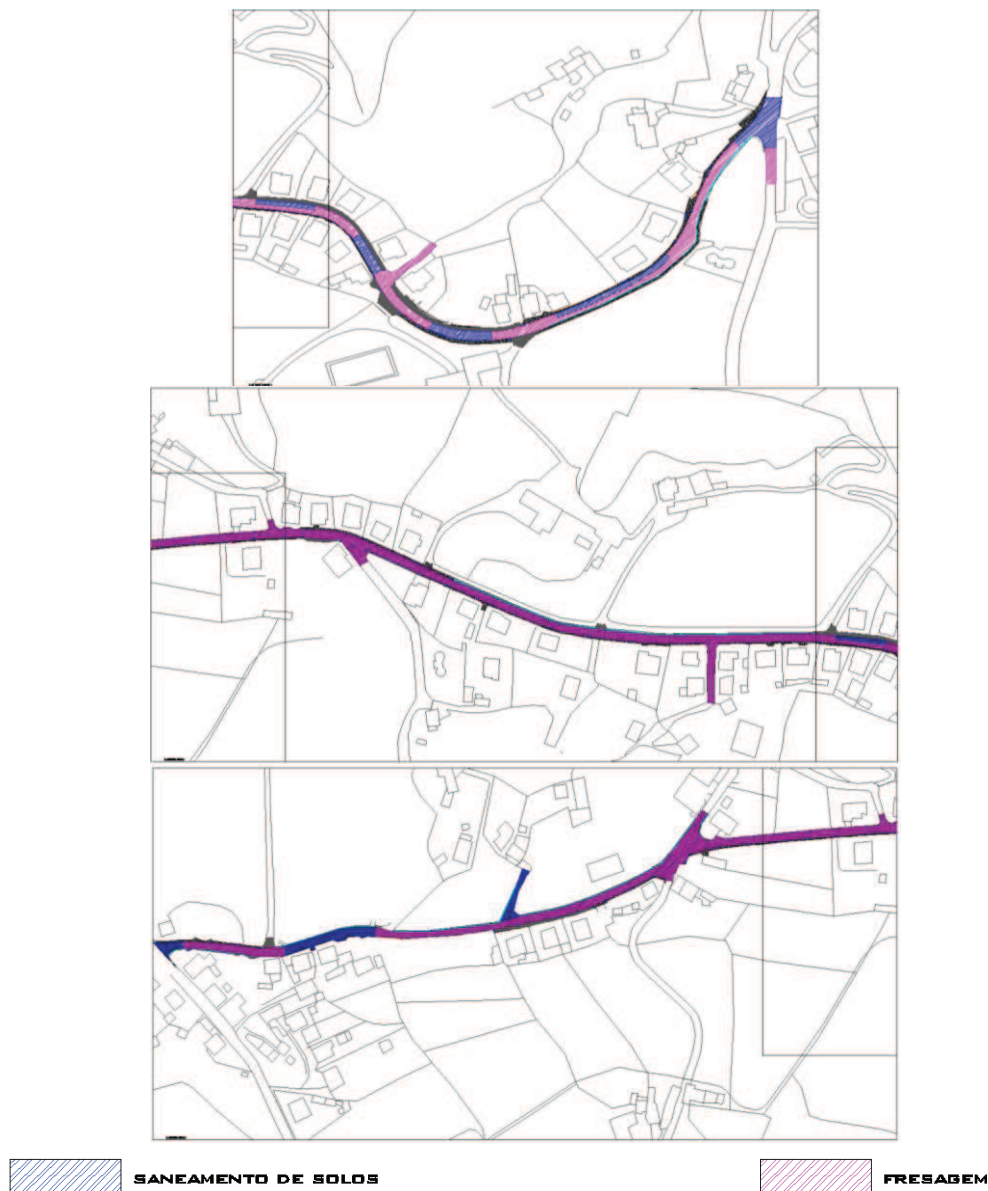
Trabalhos de pavimentação na Rua Domingos Macedo e Rua da Liberdade.
